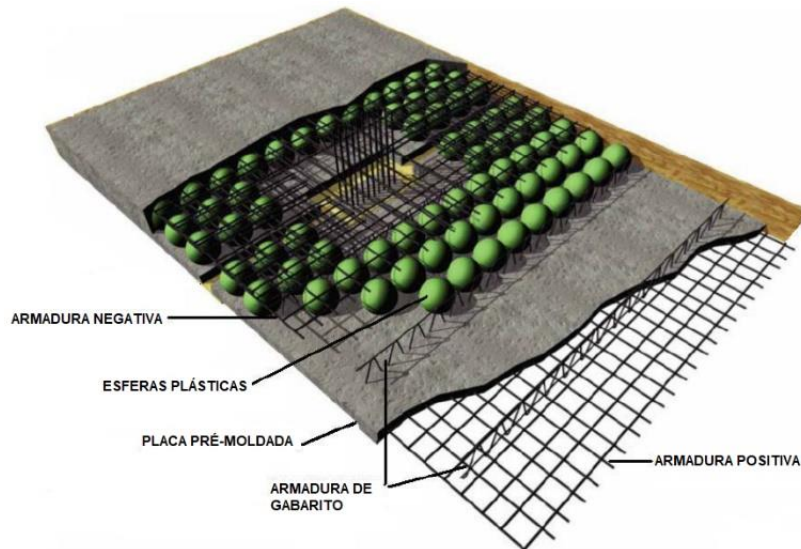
Composição da laje *BubbleDeck* (Adaptado de CHURAKOV, 2014).
